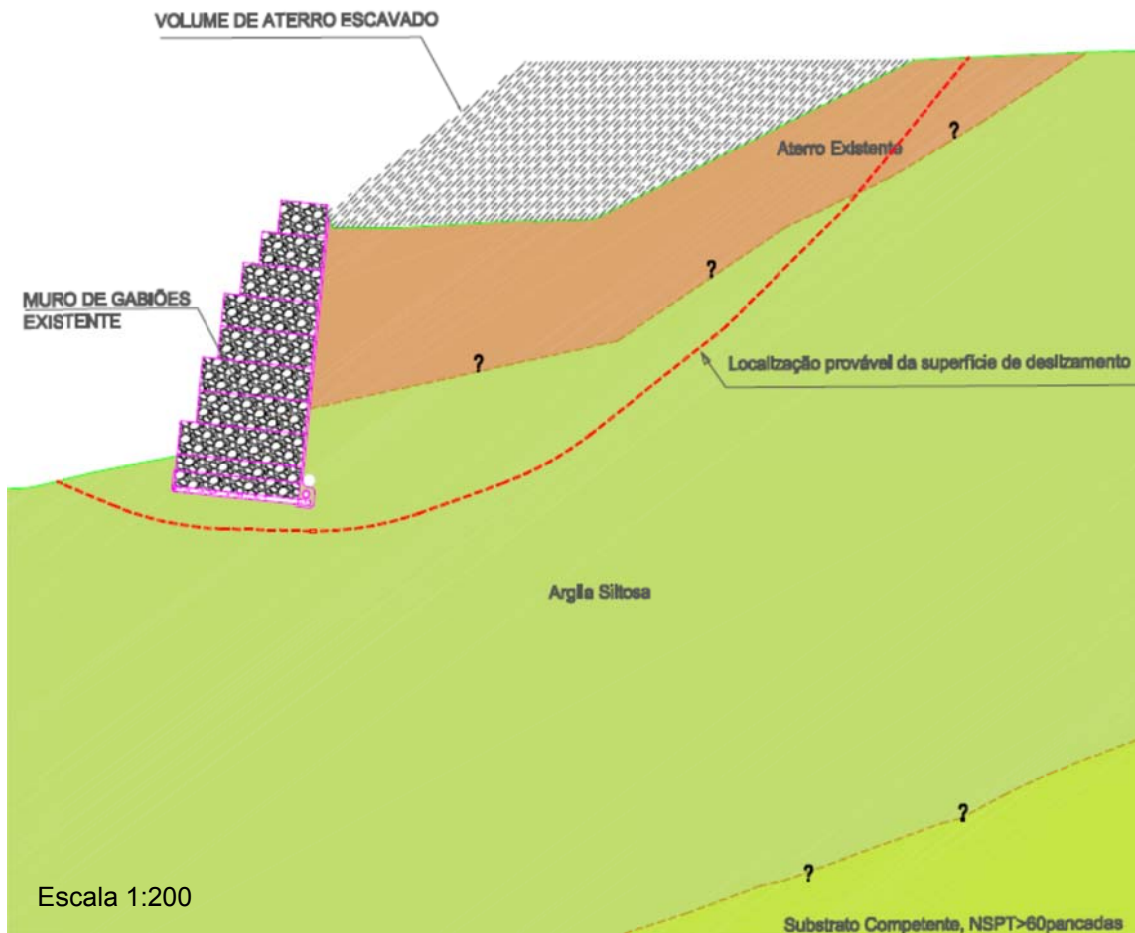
1ª Fase: Preparação dos trabalhos e escavação do aterro (corte tipo) [3].
